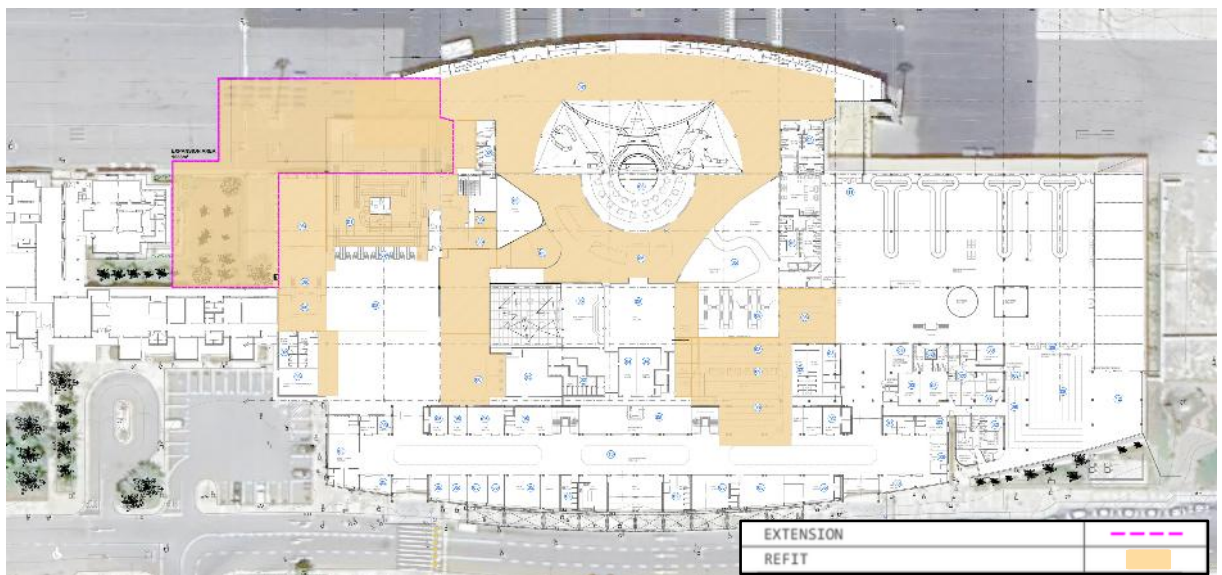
| Planta Sumária de Intervenções no Terminal SID: Extensão e Refit
